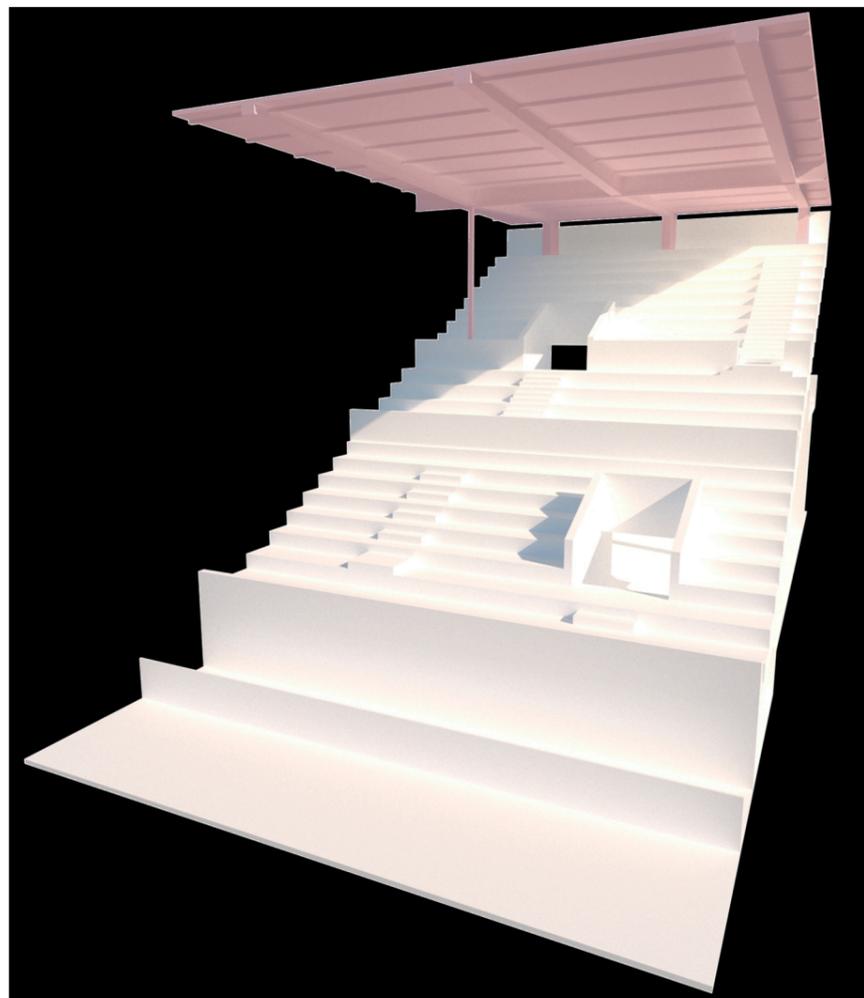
Renderización de una sección de la cubierta, donde se aprecian los apoyos que presenta. Elaboración propia.
